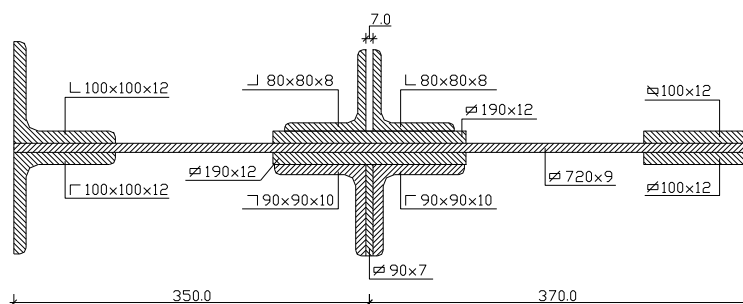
Secção do montante sobre o pilar estribo - MON_PE
